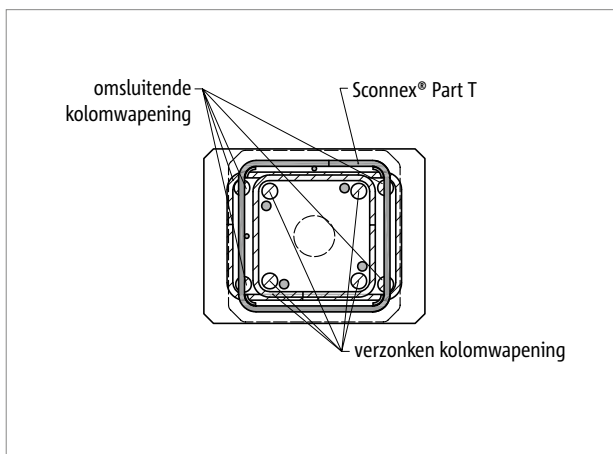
Schöck Sconnex® type P: Wapening in zone 1 - dwarsdoorsnede van de kolom
